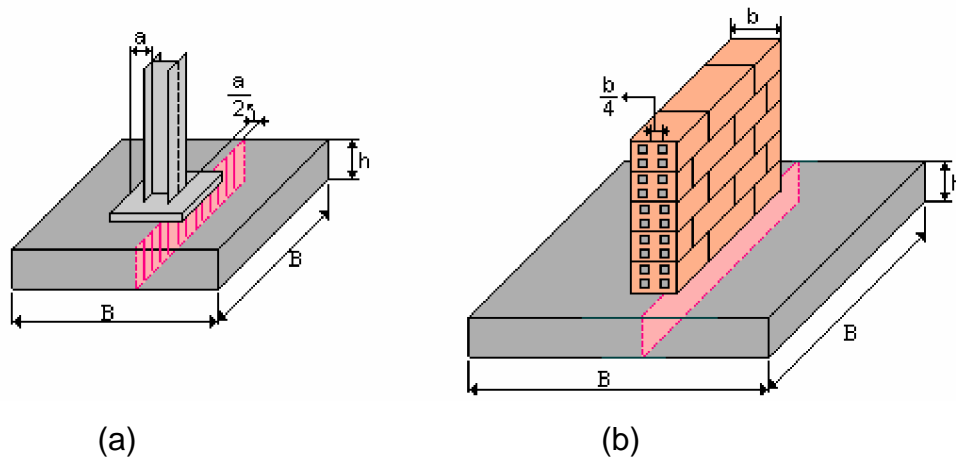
Sección crítica para el cálculo del momento en zapata que soporta columna metálica (a) y muro de mampostería estructural (b).
